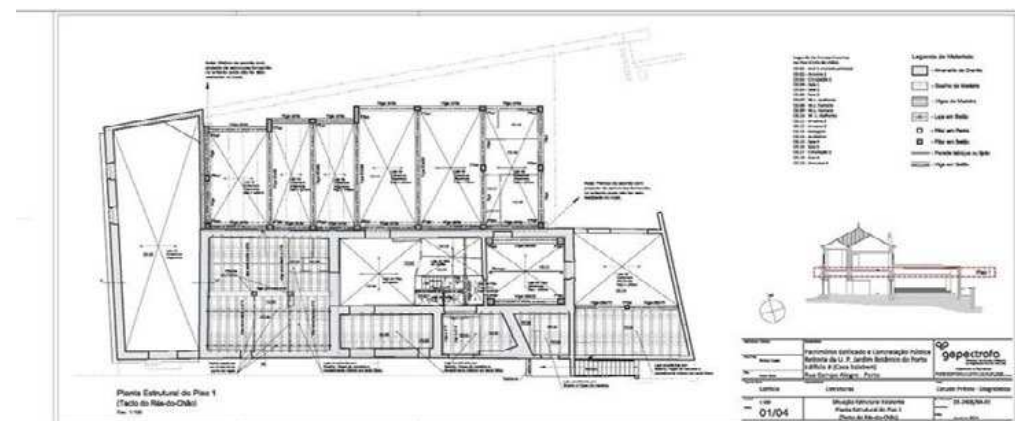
Casa Salabert – levantamento Estrutural do primeiro piso
